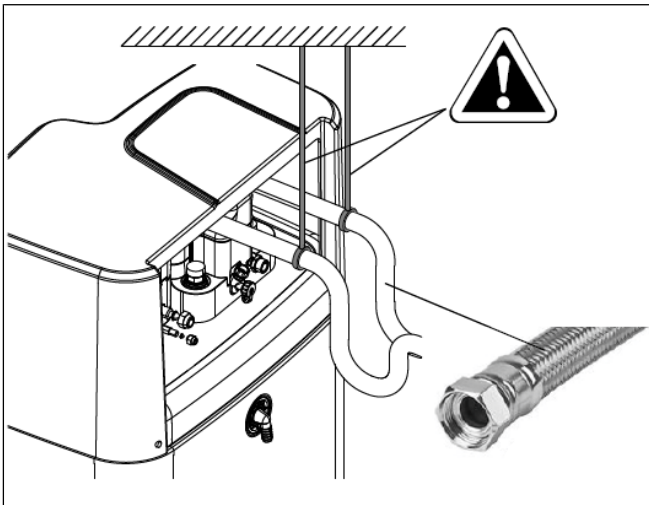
Conexión hacia atrás: apoyar las tuberías hidráulicas
